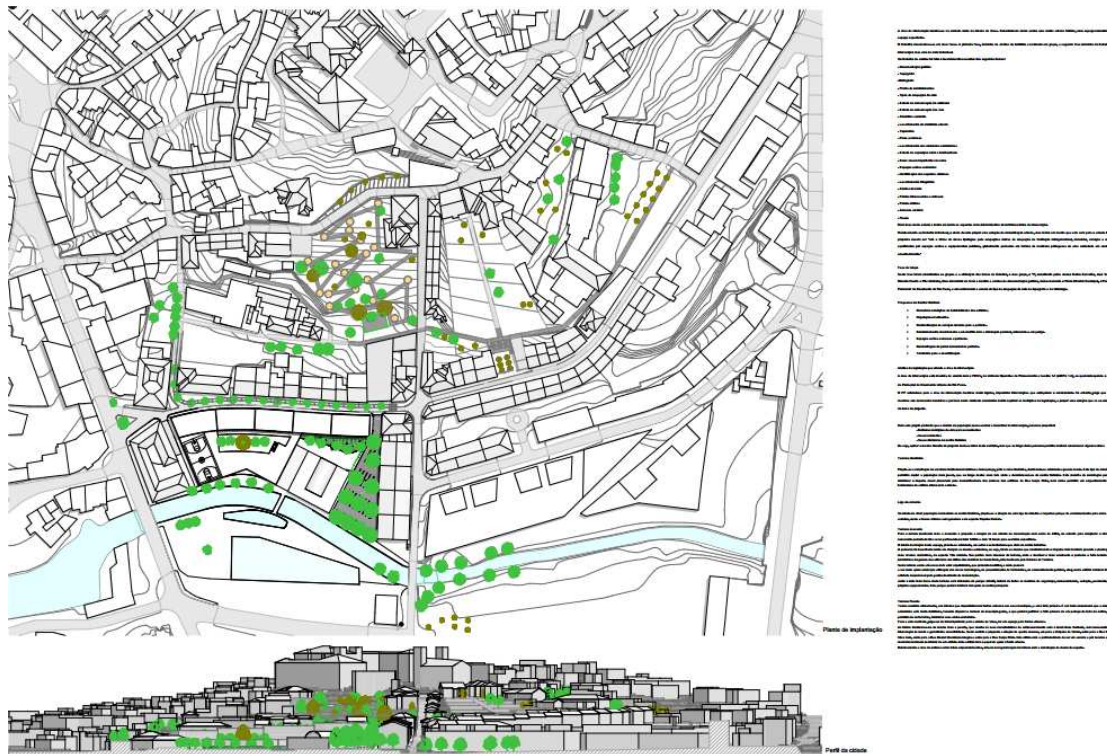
Painel final n.º1 - Habitação colectiva para jovens – Planta localização
